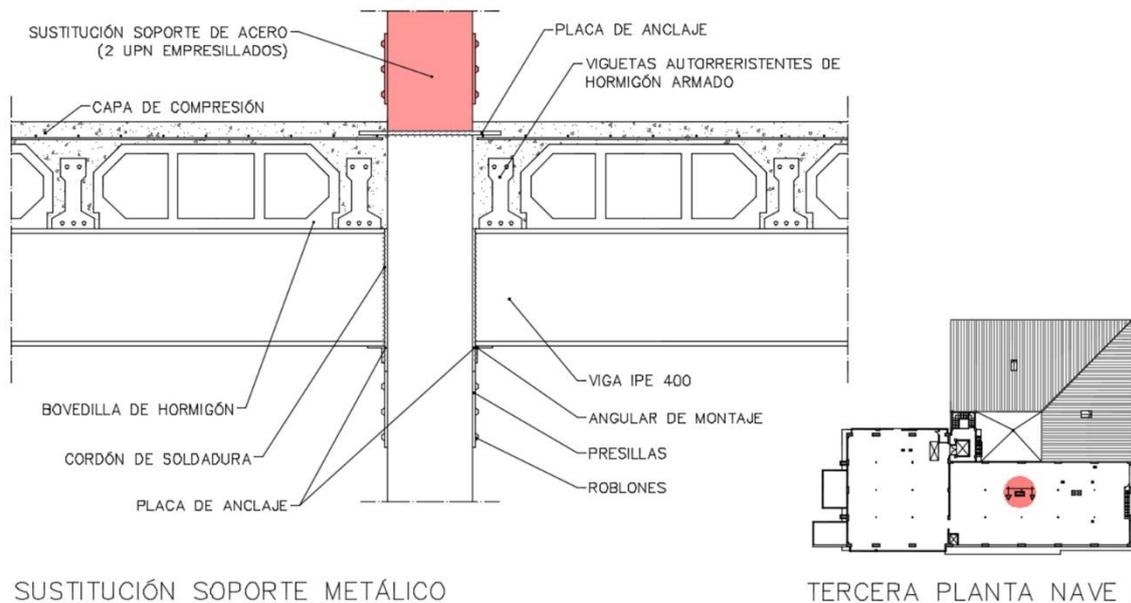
Detalle forjado unidireccional apoyado y el soporte metálico (2 UPN empresillados) a sustituir.
